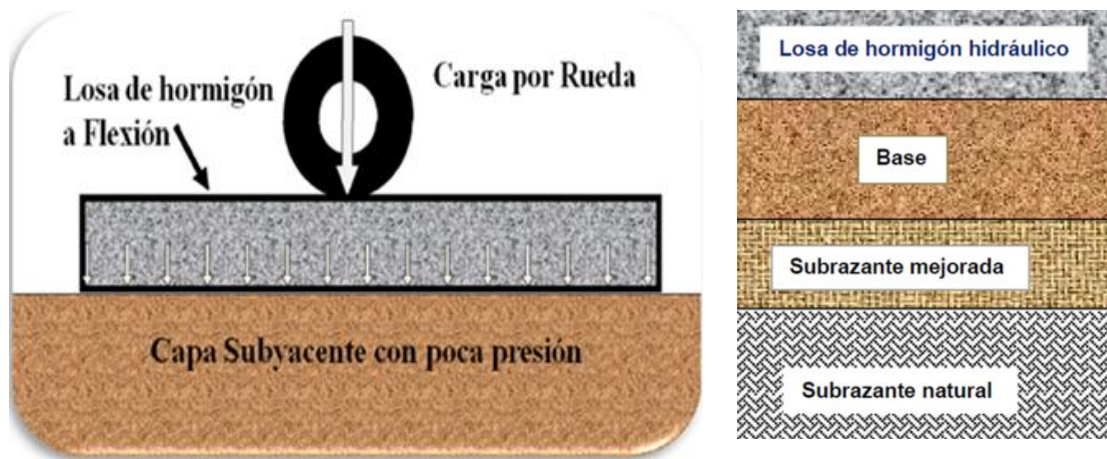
ESTRUCTURA Y COMPORTAMIENTO BAJO LA ACCION DE UNA CARGA DE UN PAVIMENTO RIGIDO
